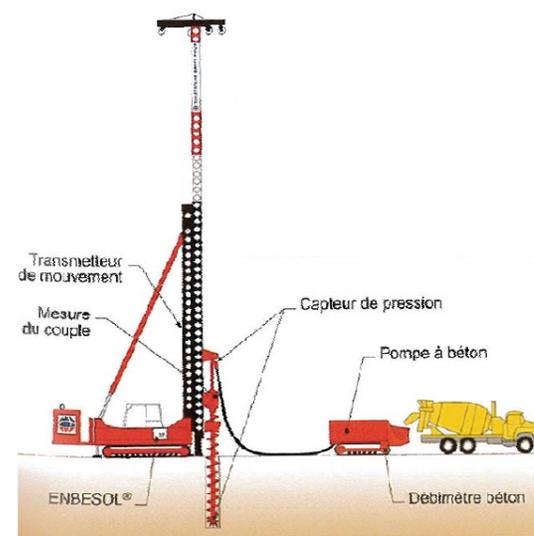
Esquema elaboración de los pilotes de cimentación.
